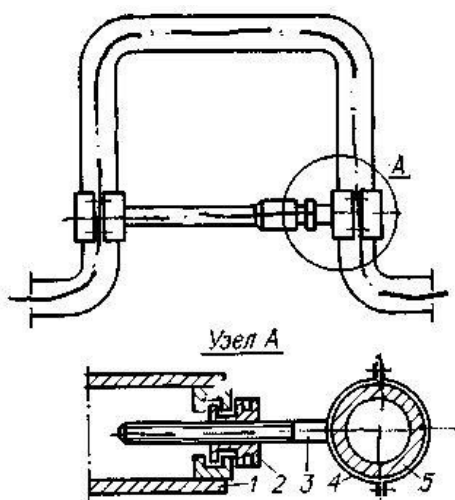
Винтовое приспособление для растяжки компенсаторов
